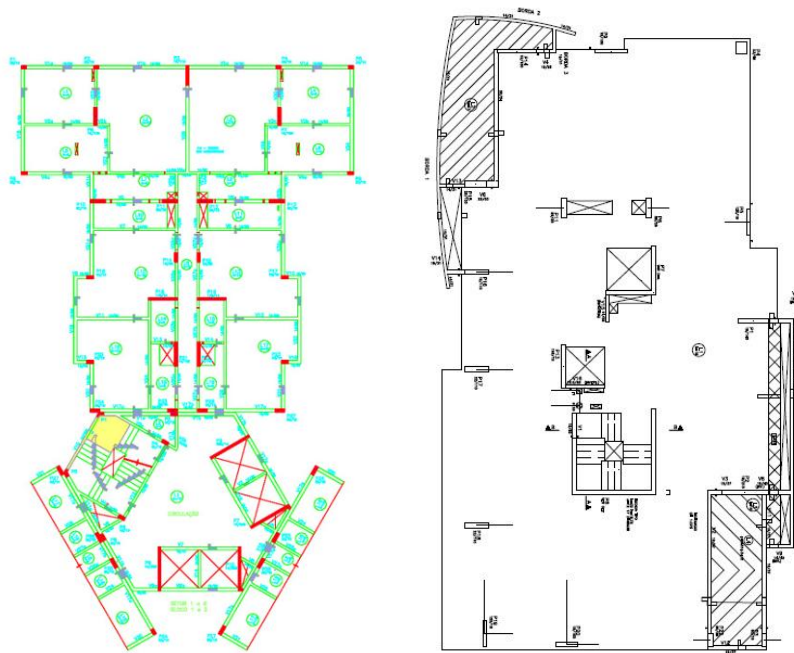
À esquerda geometria de um dos três setores constituintes do pavimento tipo, incluindo a circulação do empreendimento executado em concreto armado. À direita, geometria do pavimento tipo do edifício constituído por lajes planas protendidas. Fonte: Construtoras responsáveis pela execução dos empreendimentos A e B.
